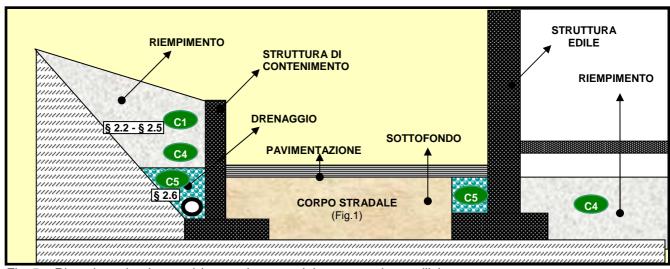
Riempimenti e drenaggi (costruzione stradale e costruzione edile)
